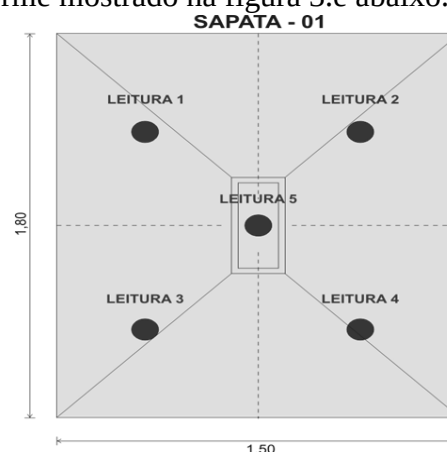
e: Vista da planta-baixa para esquema de cravação do CPE na sapata escavada.
